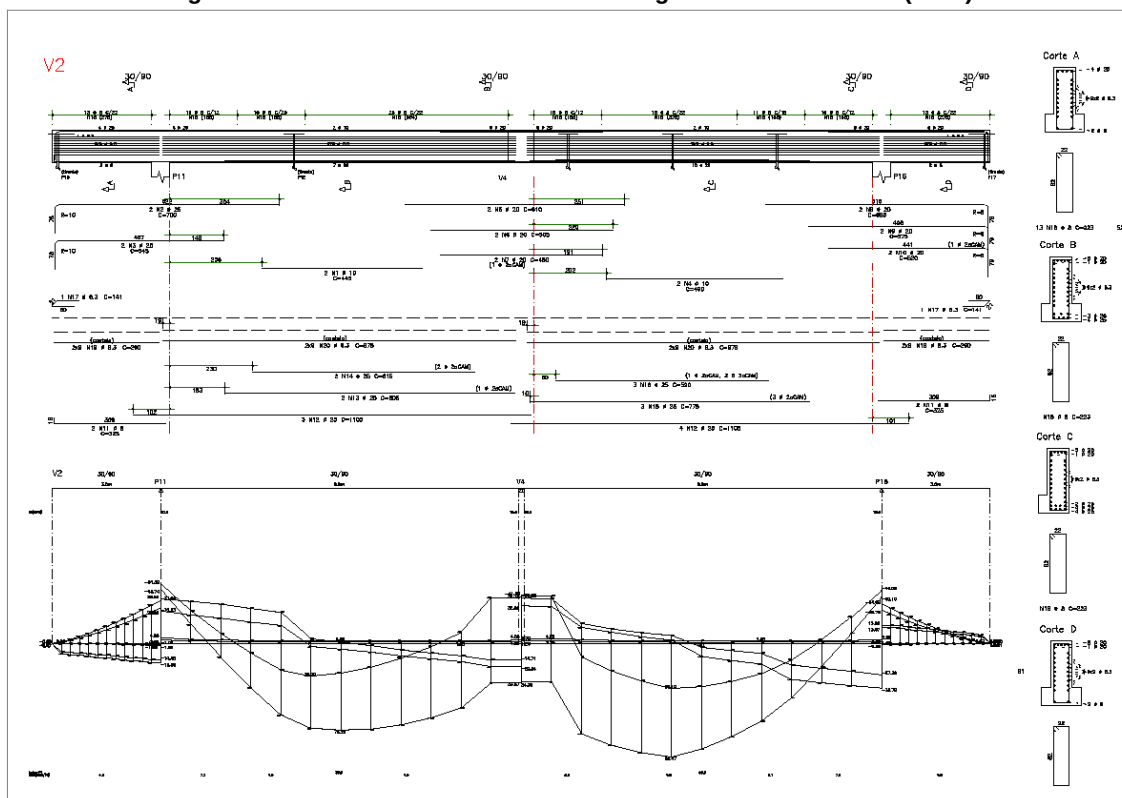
Cobertura: detalhamento da viga V2. Fonte: AUTOR (2017).
